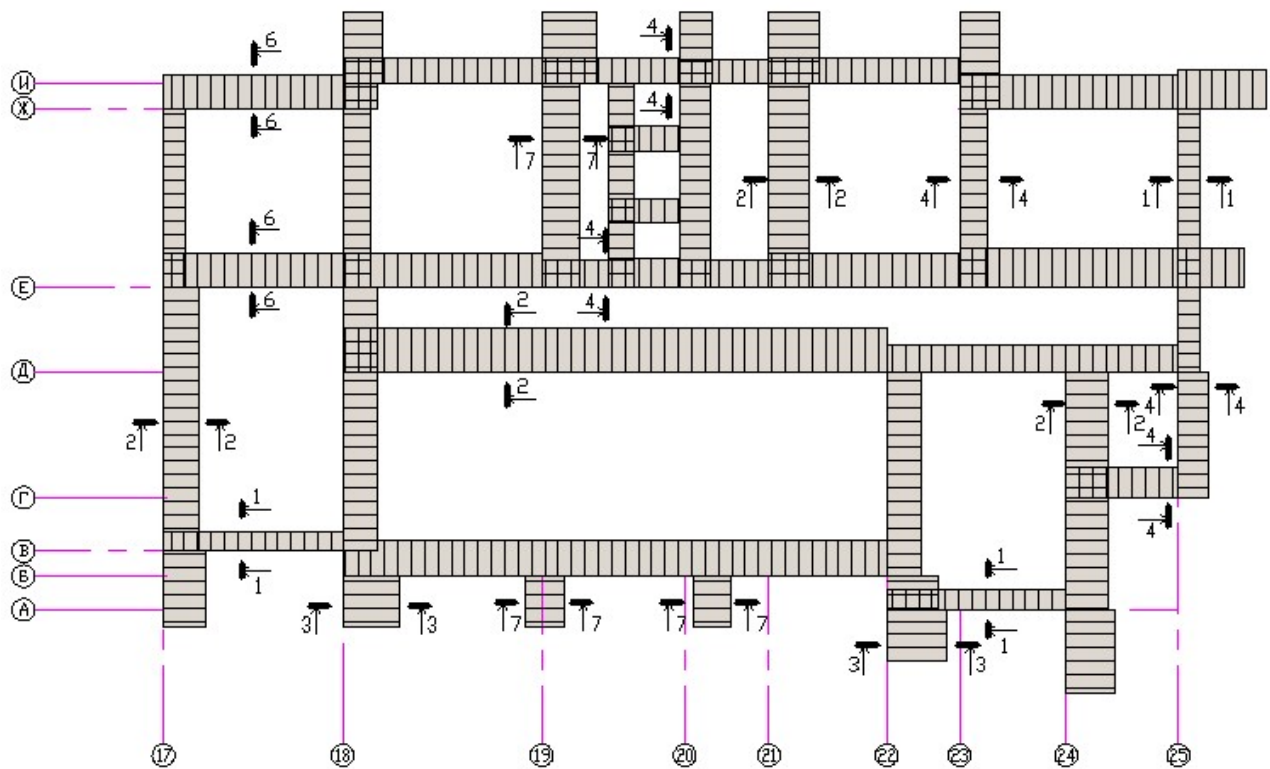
Схема навантажень на фундаменти. Секція №1
